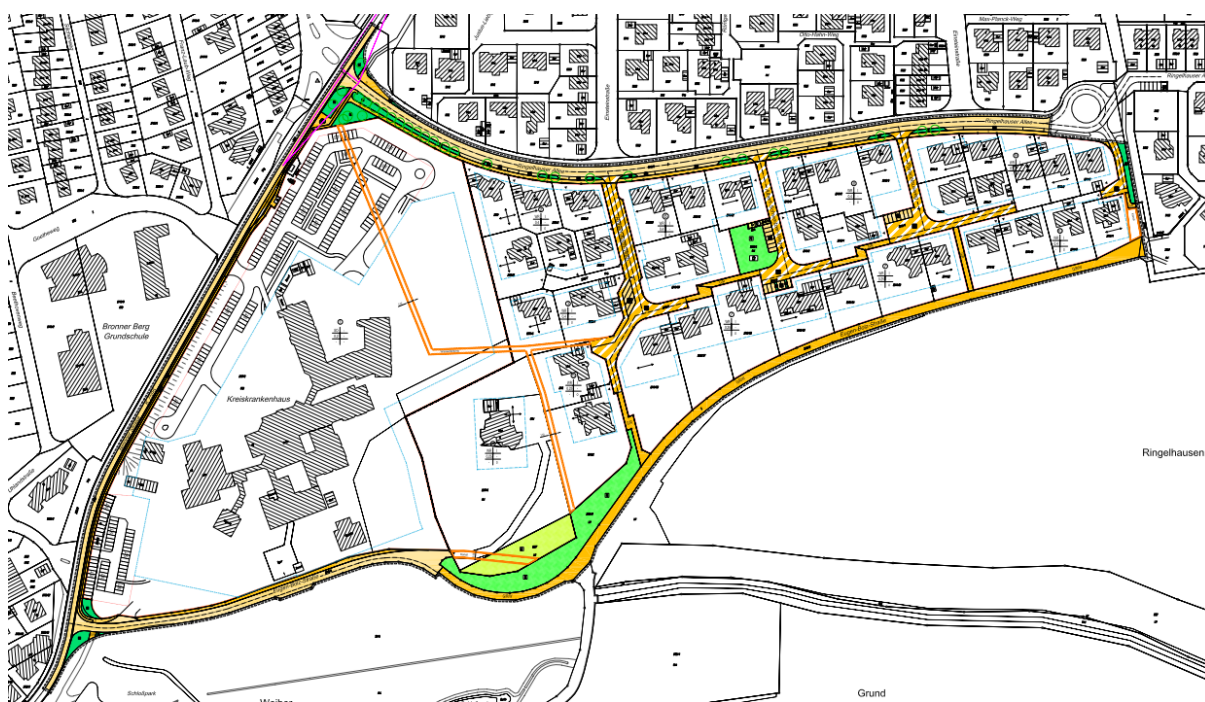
Rechtsgültiger Bebauungsplan „Im Grund I Änderung und Neufassung“, 21.12.1995
